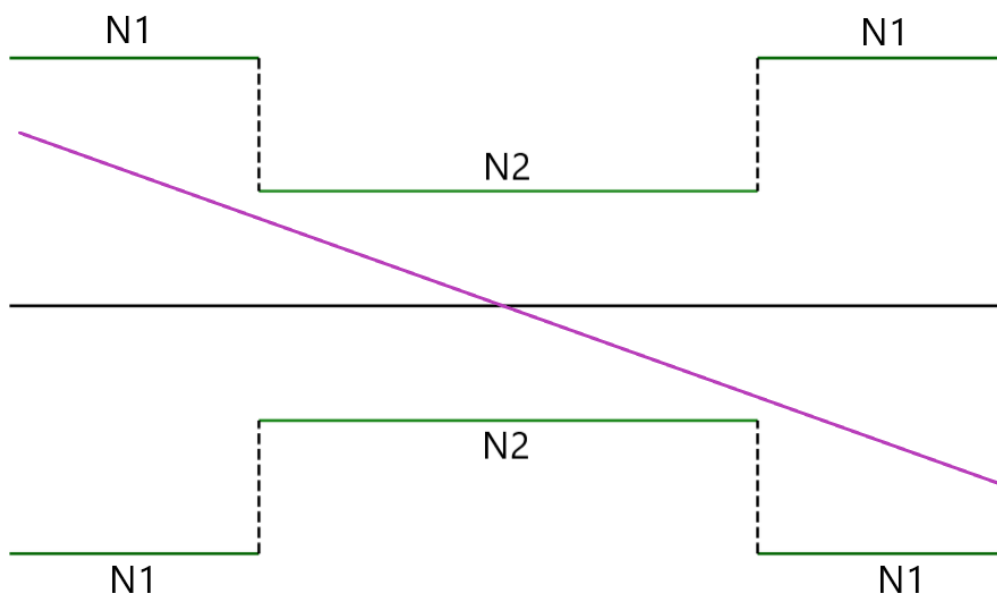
Imagem ilustrativa da disposição das armaduras transversais
